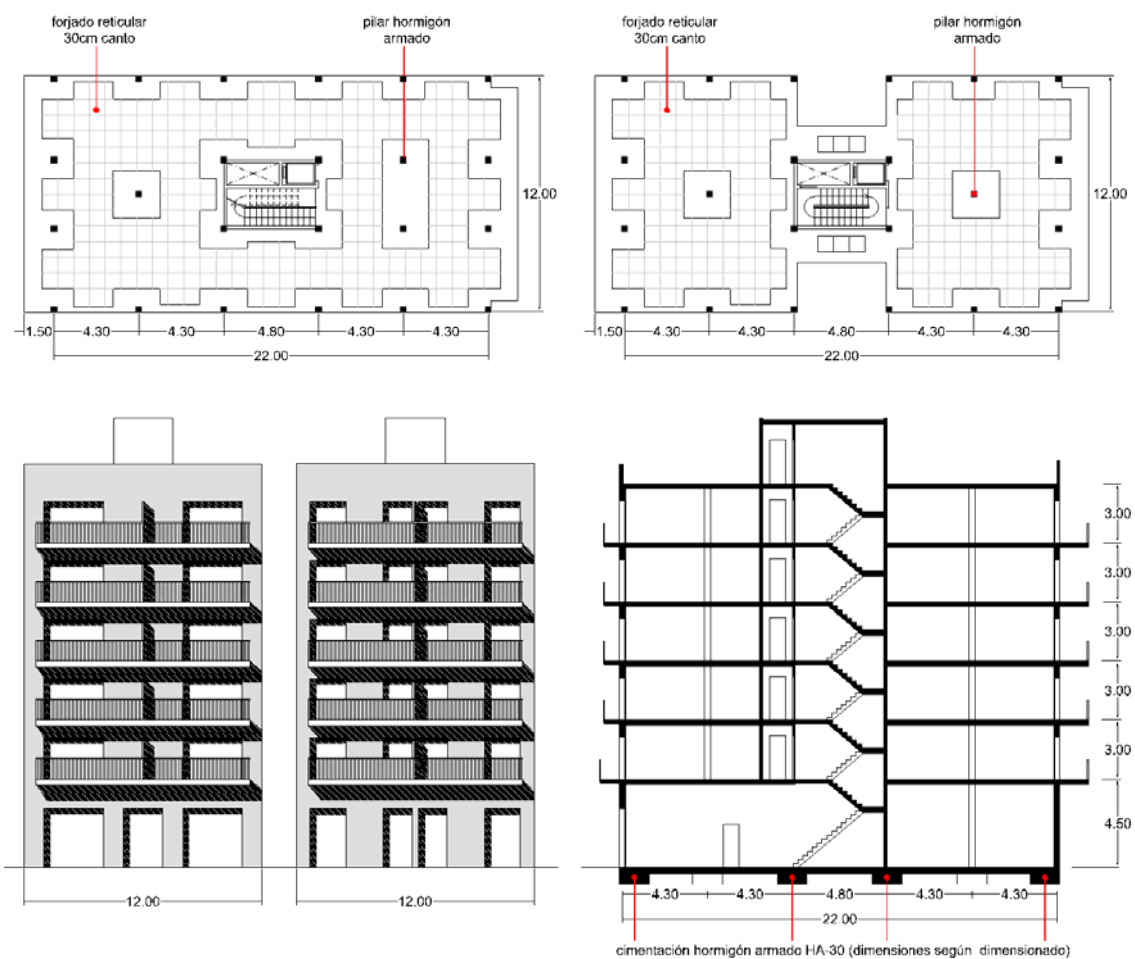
h Plantas, alzados y sección del modelo III.5
